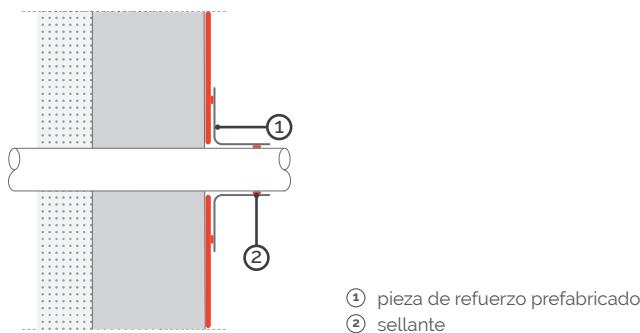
Encuentro de la barrera tipo lámina con un elemento pasante horizontal mediante una pieza de refuerzo prefabricada
